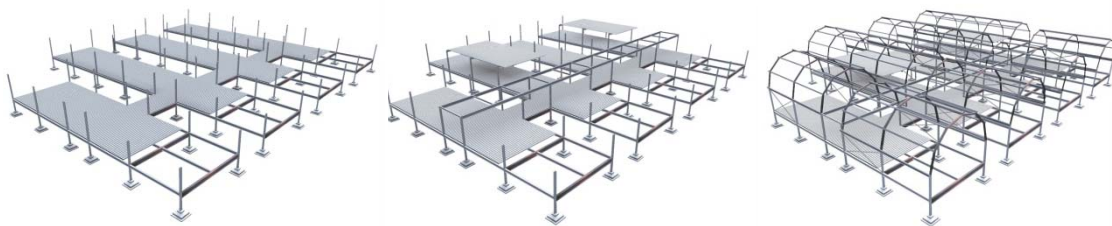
3d strutturale. Fonte: elaborazione grafica dell'autore
